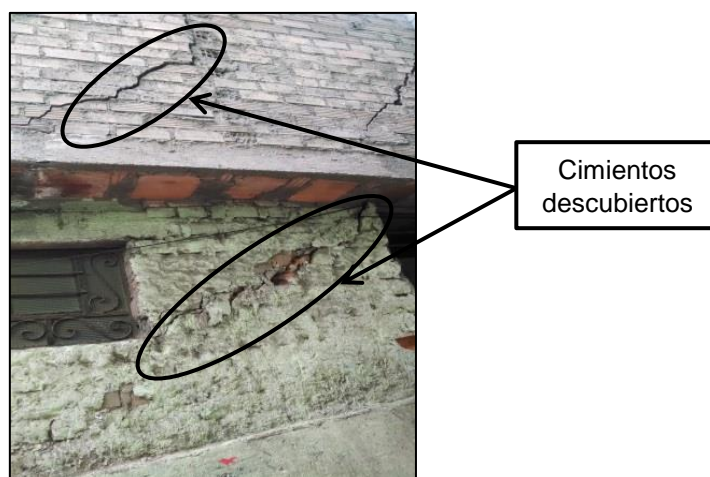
Viviendas ubicadas en pendientes elevadas.
